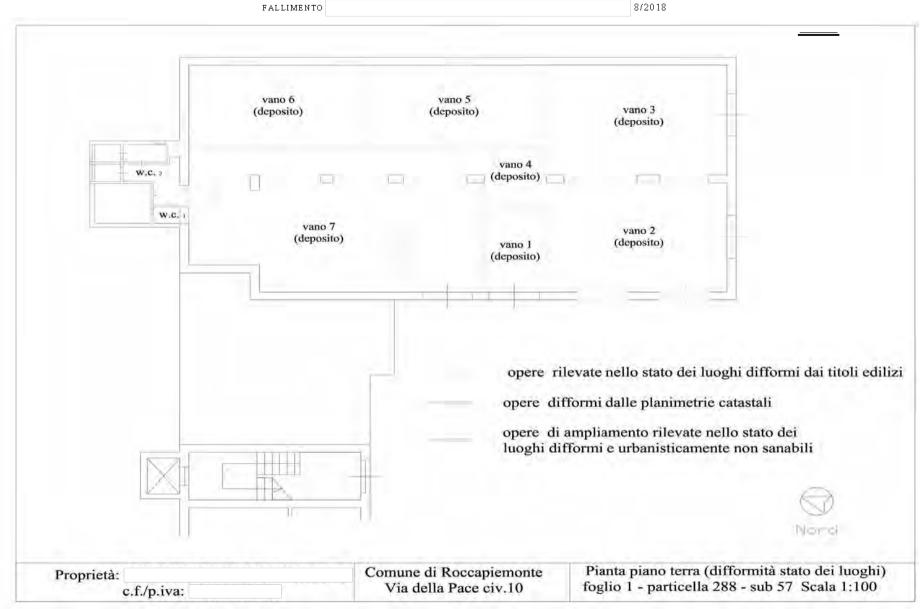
' - rappresentazione planimetrica difformità stato dei luoghi locale commerciale fgl. 1 p.lla 488 sub 57
